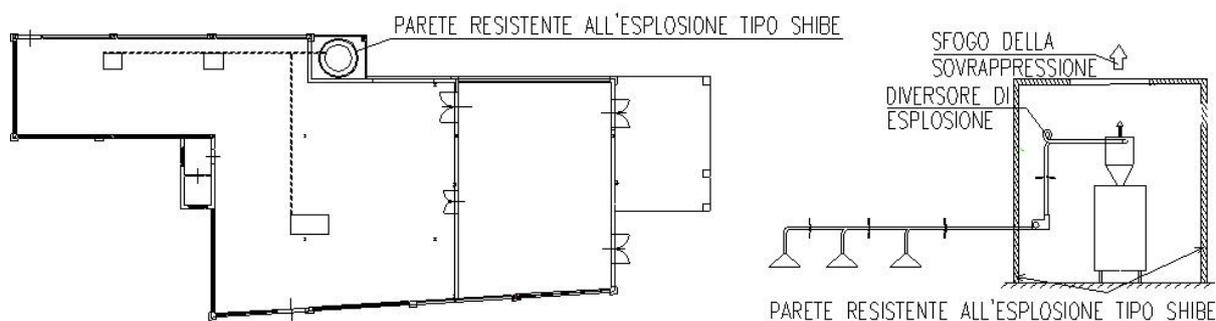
Rappresentazione schematica del condotto di aspirazione protetto.
